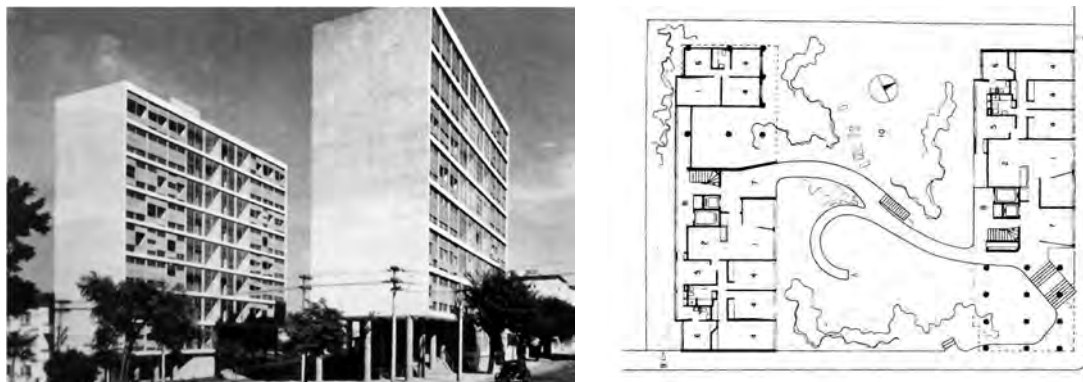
Edifício Louveira (1946), foto e planta térreo (Fonte: MINDLIN, 1999).
